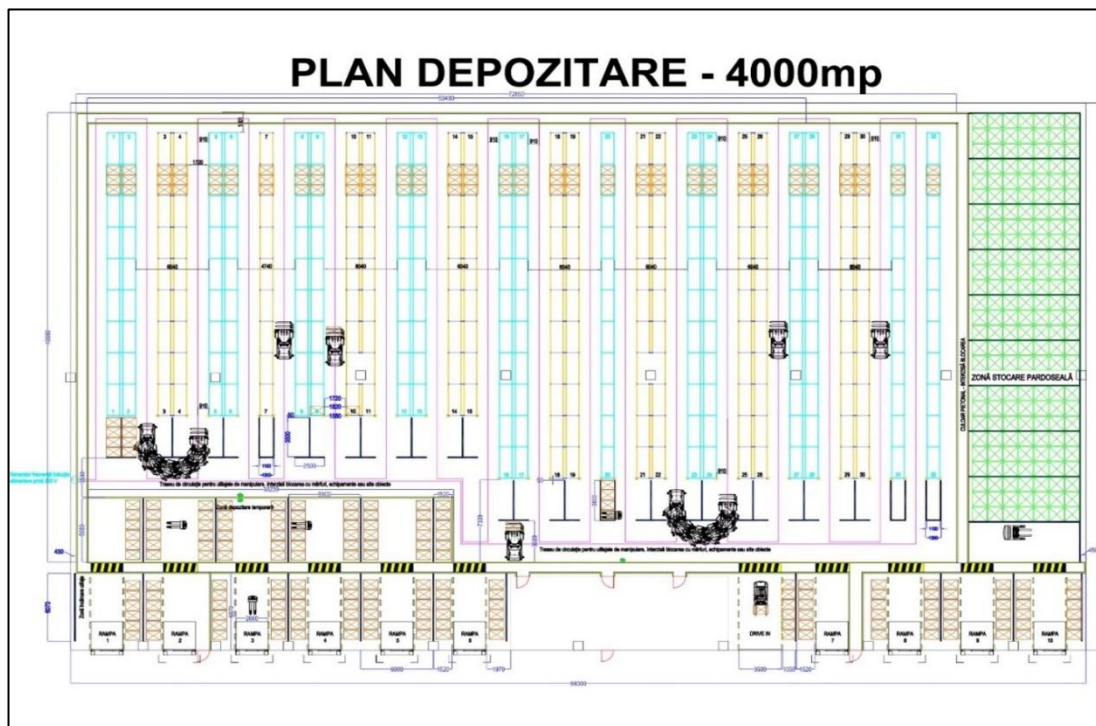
Plan depozitare cu 32 de rafturi și zonă de stocare pardoseală
